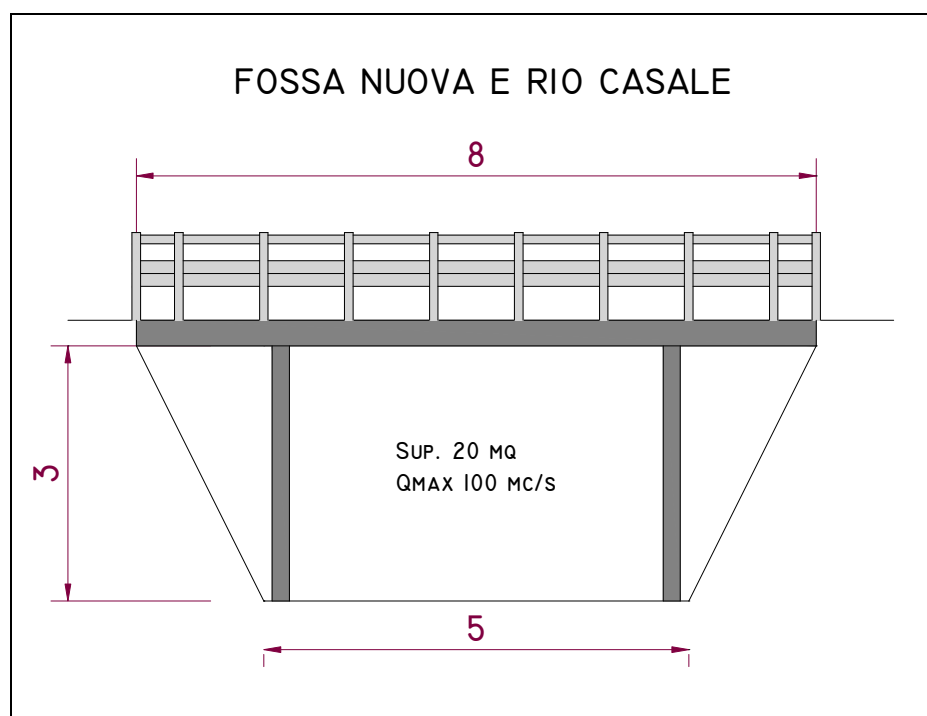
Sezione Fossa Nuova e Rio Casale (Foto 6 - Tav. 2)
